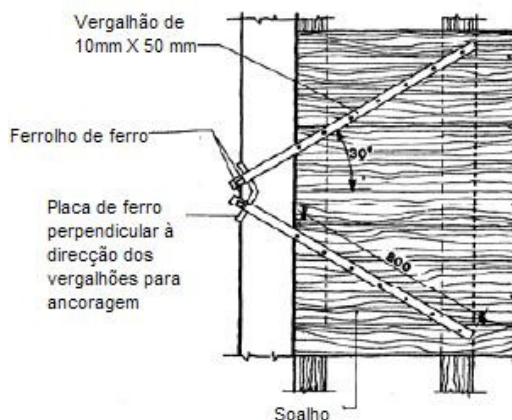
Utilização de vergalhões de aço na ligação pavimento-parede em planta (Lombardo et al.;1997).
